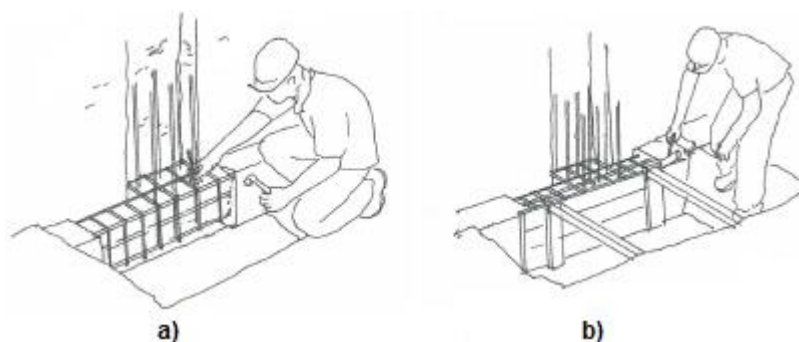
Trabalho na fundação existente: a) realização da armadura; b) execução da cofragem [55]
